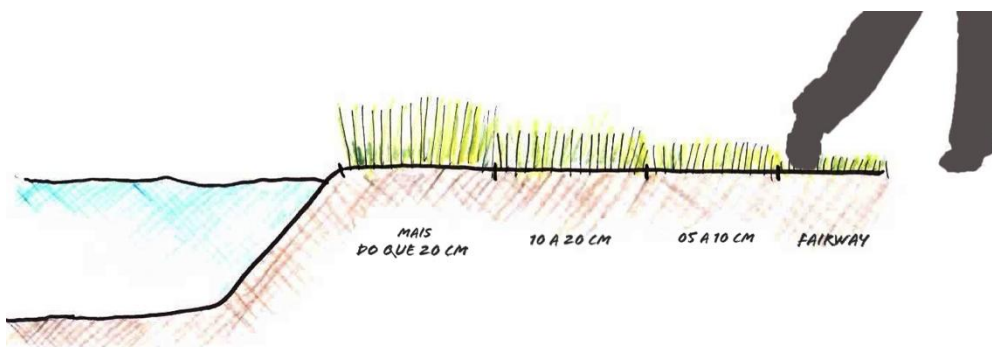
Corte tipo-Estratégia A aplicando no lago central.
